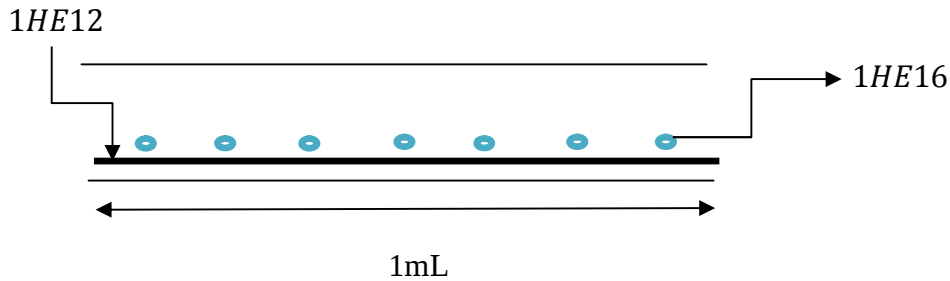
Schéma de ferrailage de la semelle filante dans le sens // L.
